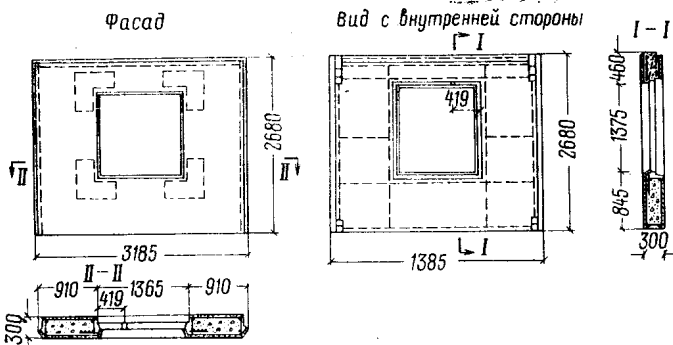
Однослойная наружная стеновая панель из легкого бетона
